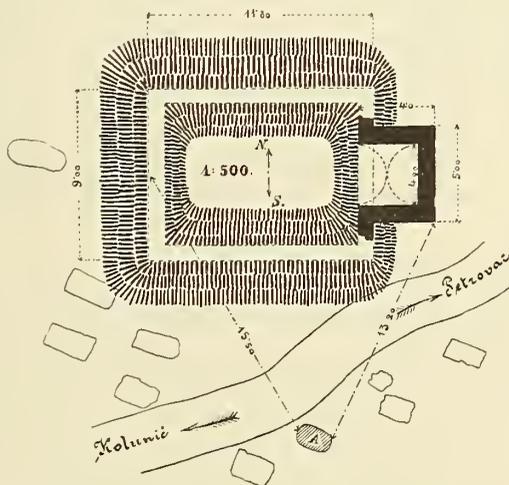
Grundriss der Kirchenruine Panagjur bei Kolunići.
